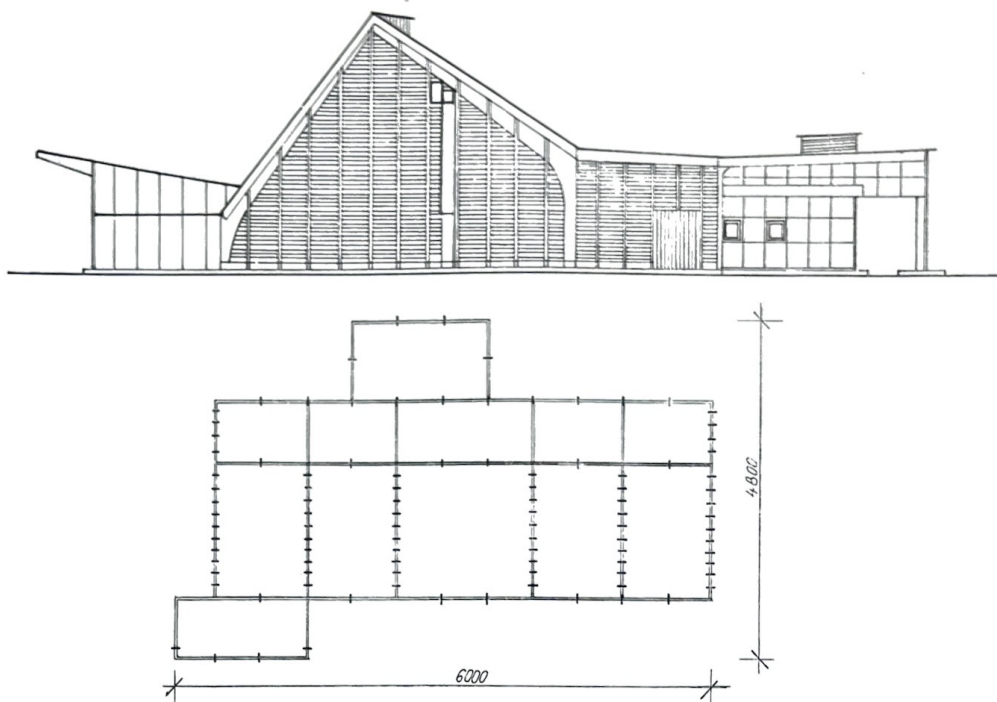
Konstrukcija pilanske zgrade (Drevina-Turany)
